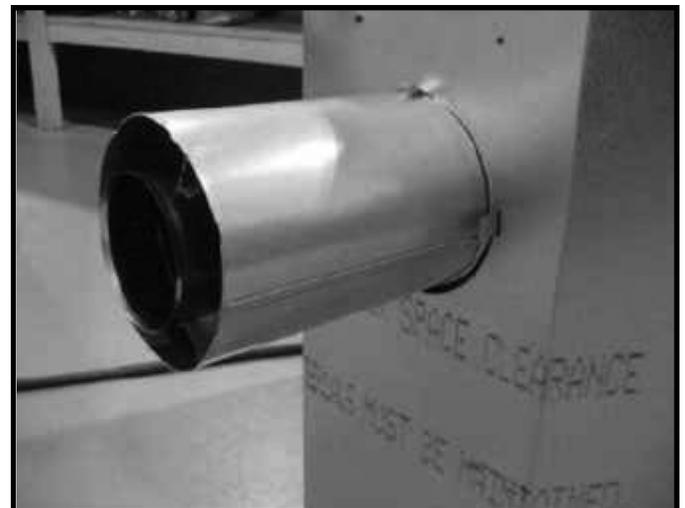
Poser la première section du conduit d'évacuation (elle se met en place en provoquant un bruit sec). Glisser le joint d'isolation sur cette section du conduit, contre le foyer, en passant sur les languettes.
